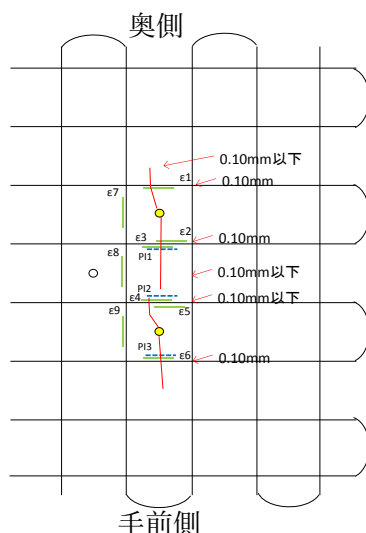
参照データ取得位置とひび割れ発生状況（STEP3）
